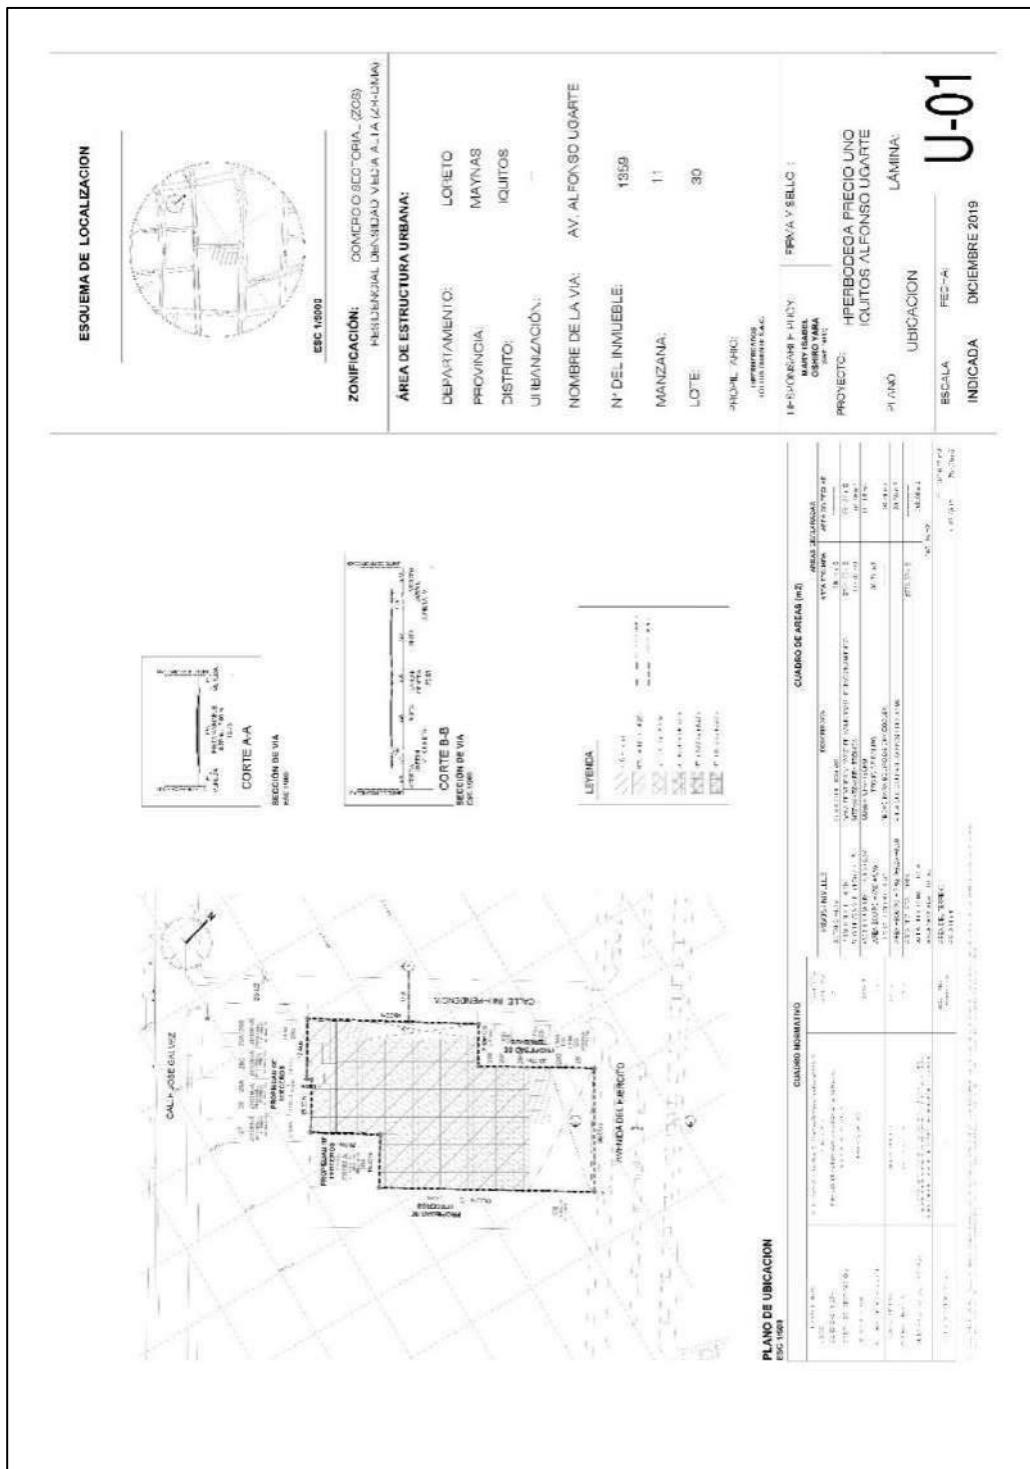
Plano de Ubicación- Iquitos Alfonso Ugarte
